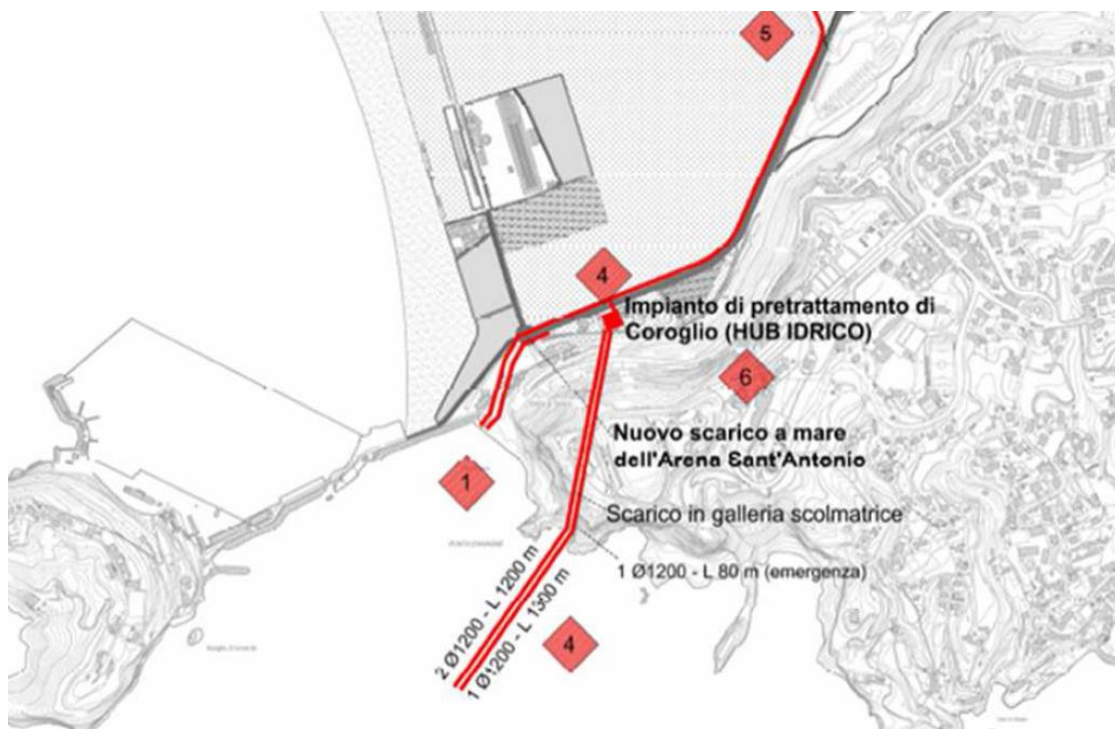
Planimetria schematica delle opere idrauliche di progetto
